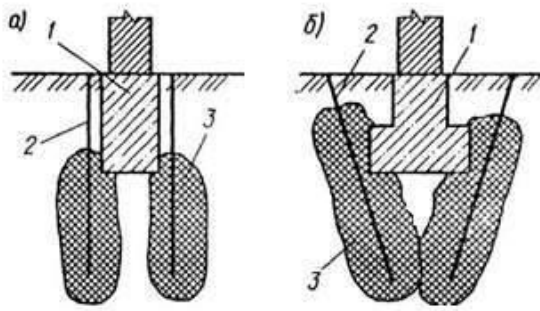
Схеми посилення фундаментів за допомогою ін'єкторів: а – вертикальна; б – похила; 1 – фундамент, що посилюється; 2 – ін'єктори; 3 – смола
